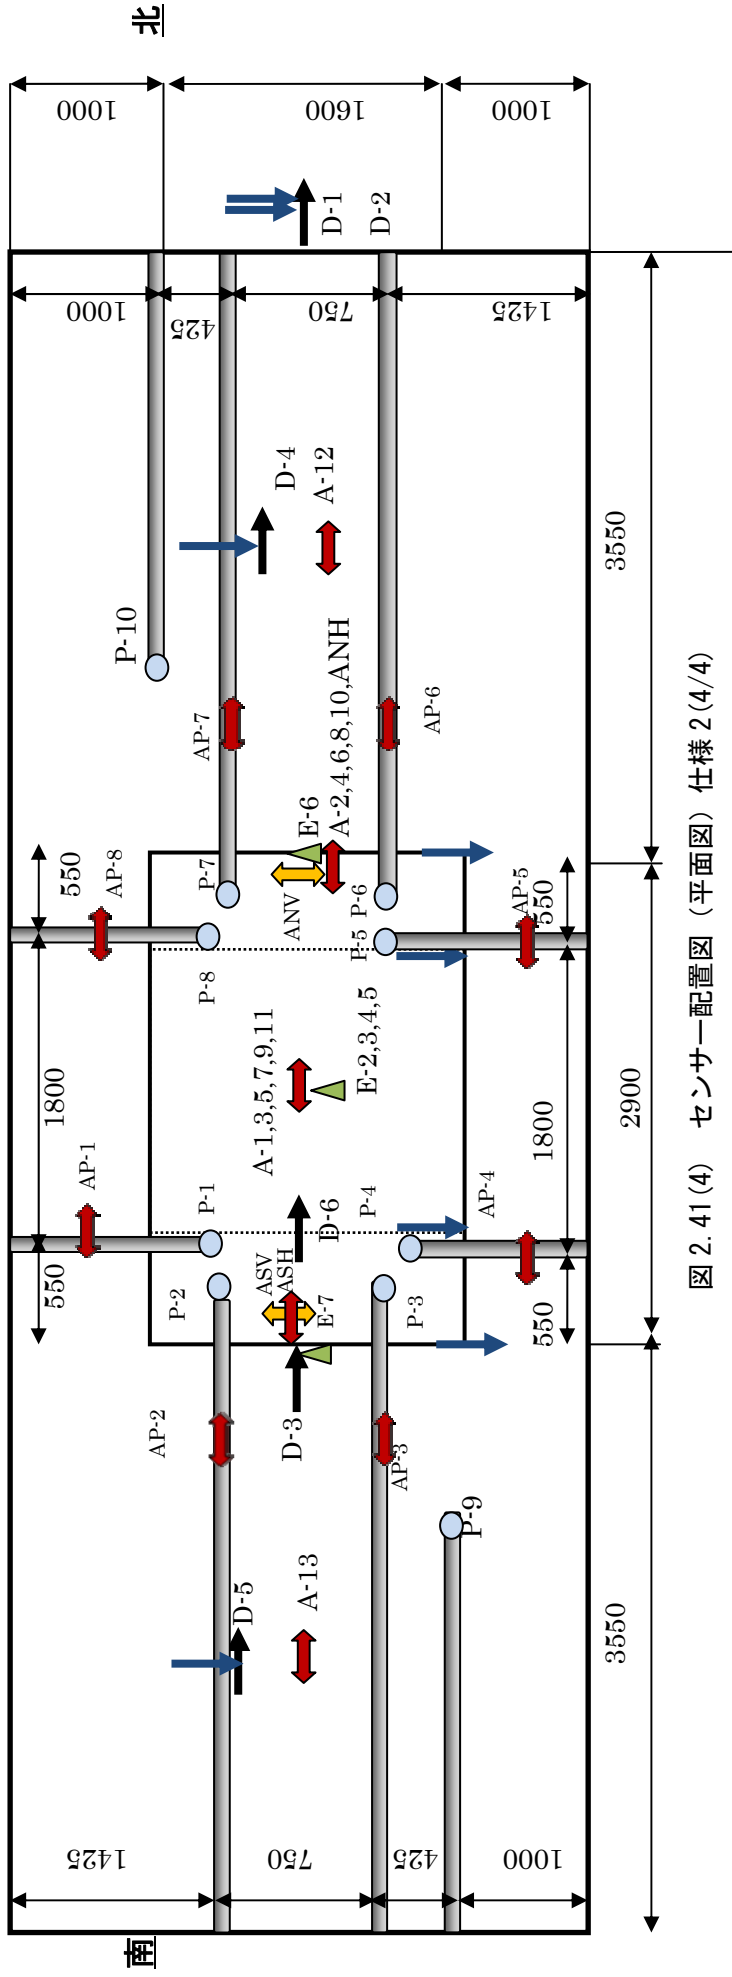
(4) センサー配置図 (平面図) 仕様 2 (4/4)
